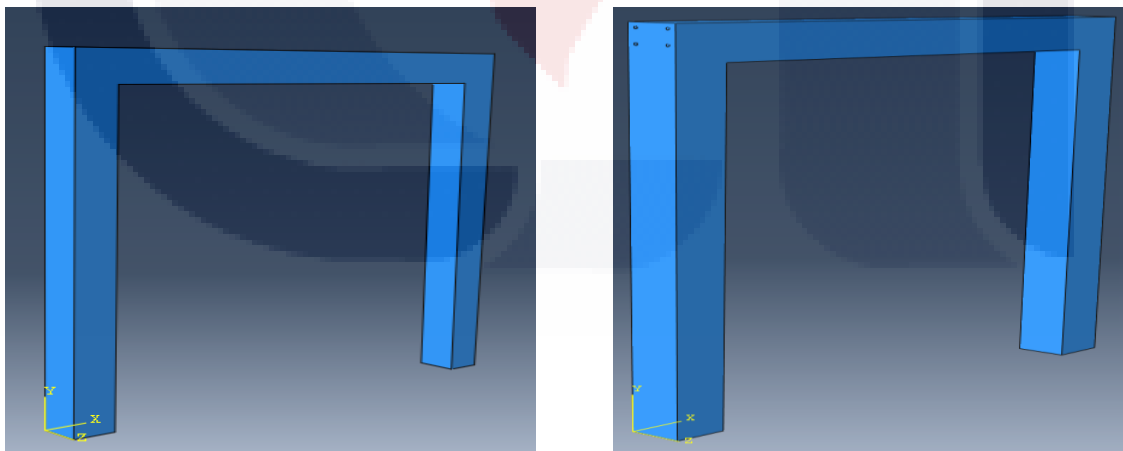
Marco de concreto con columnas y traveses sin refuerzos y con refuerzo.
